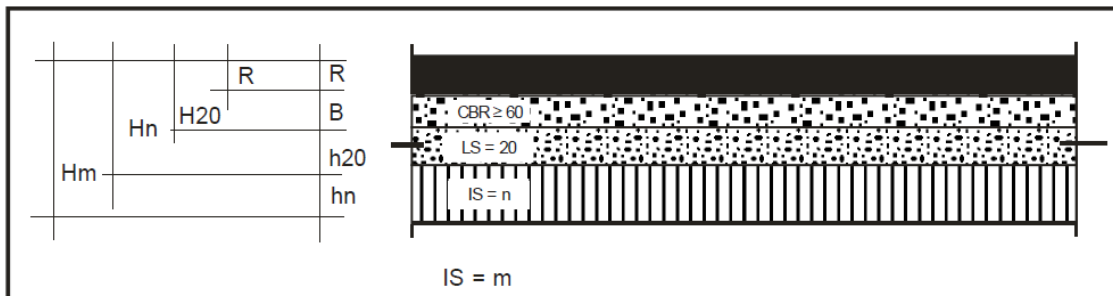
Dimensionamento do pavimento (DNIT, 2006).
